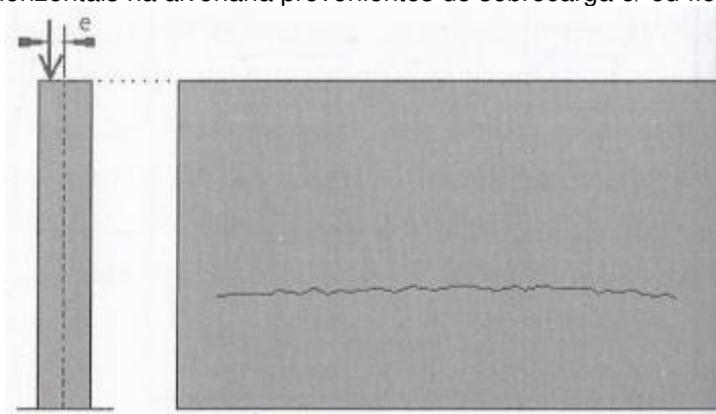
Fissuração típica da alvenaria causada por sobrecarga vertical
